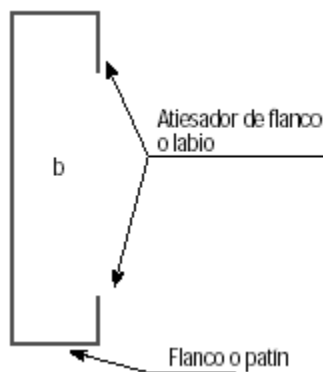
Elemento poste-viga de acero laminado en frío y sección.
